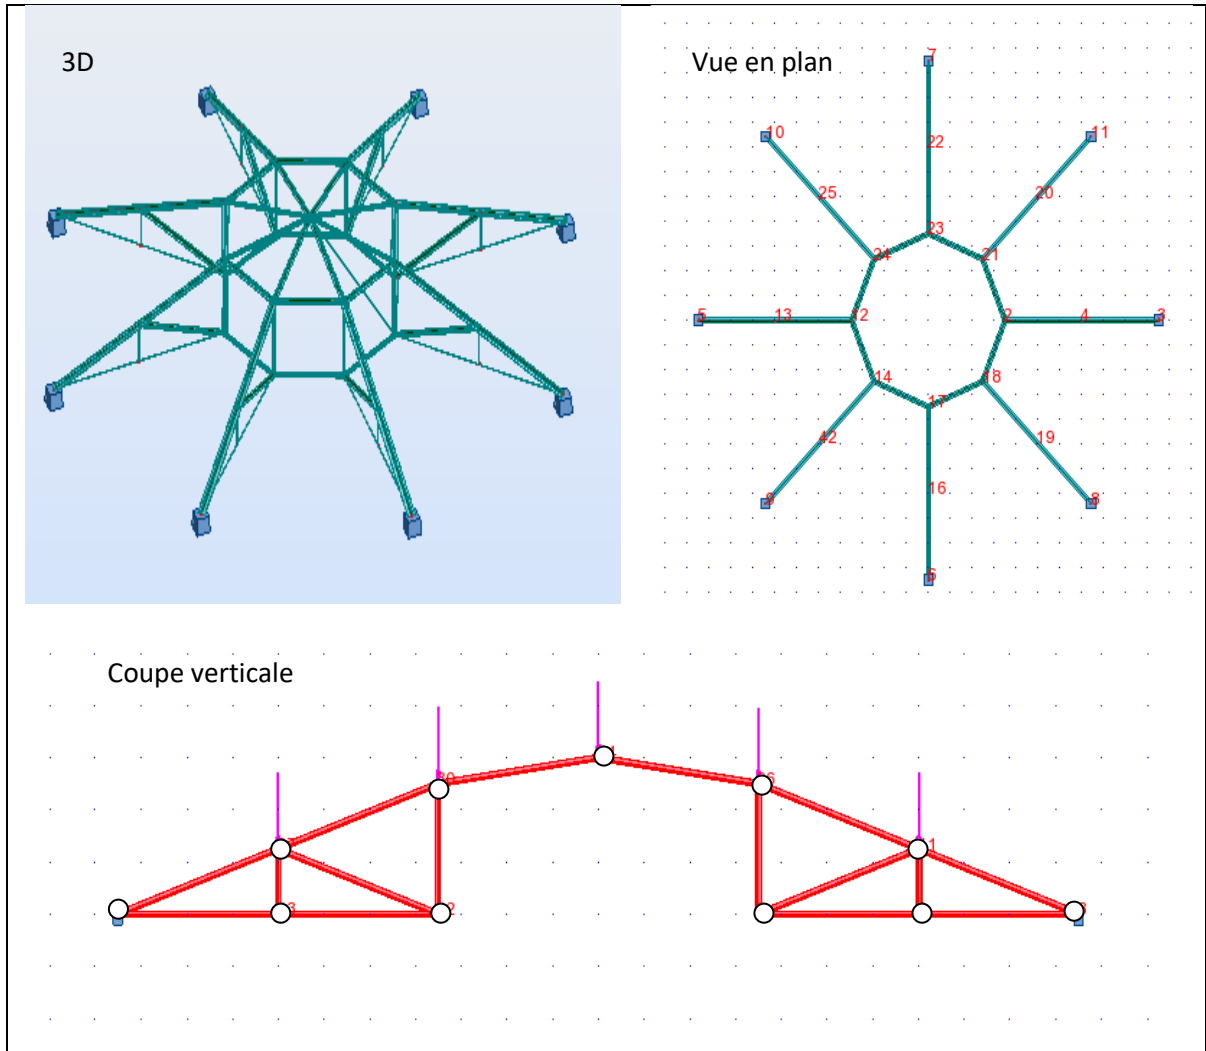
Vue générale de la structure (3D, Coupe verticale, Vue en plan)
